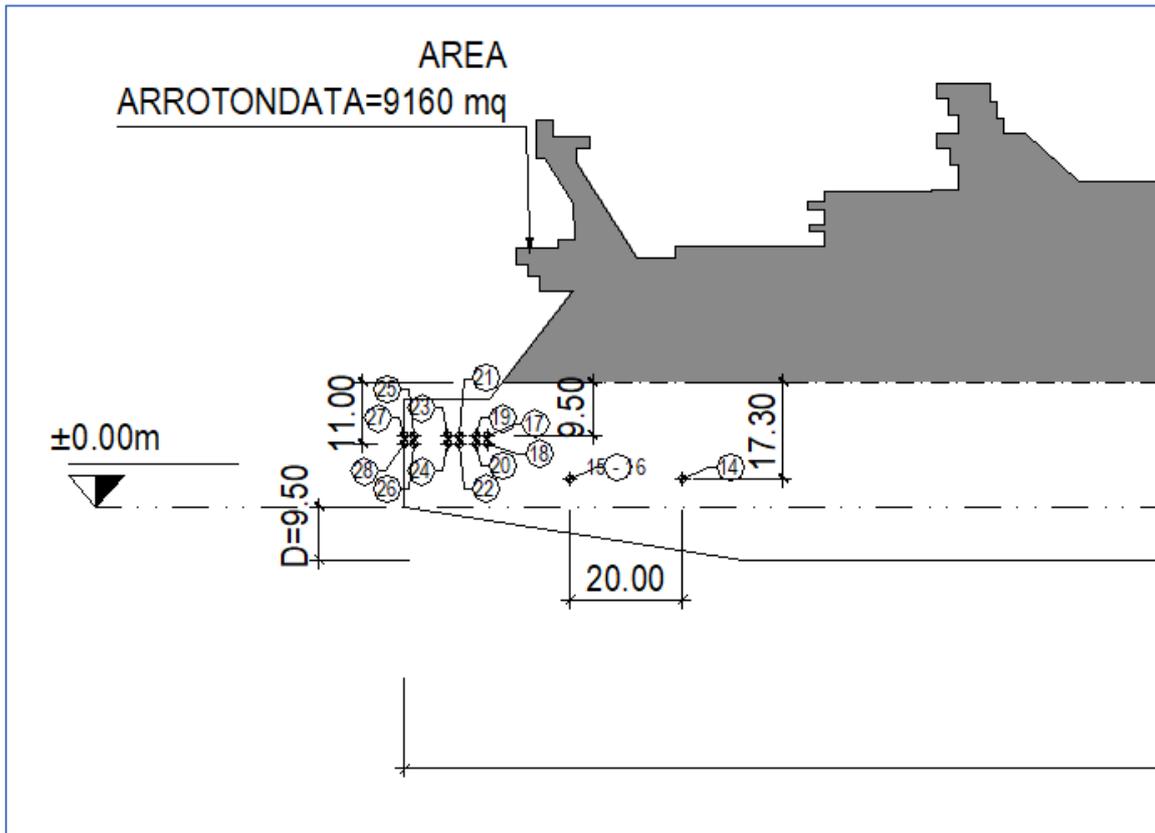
Posizione dei passacavi per le cime di ormeggio a poppa e lungo la murata della nave
